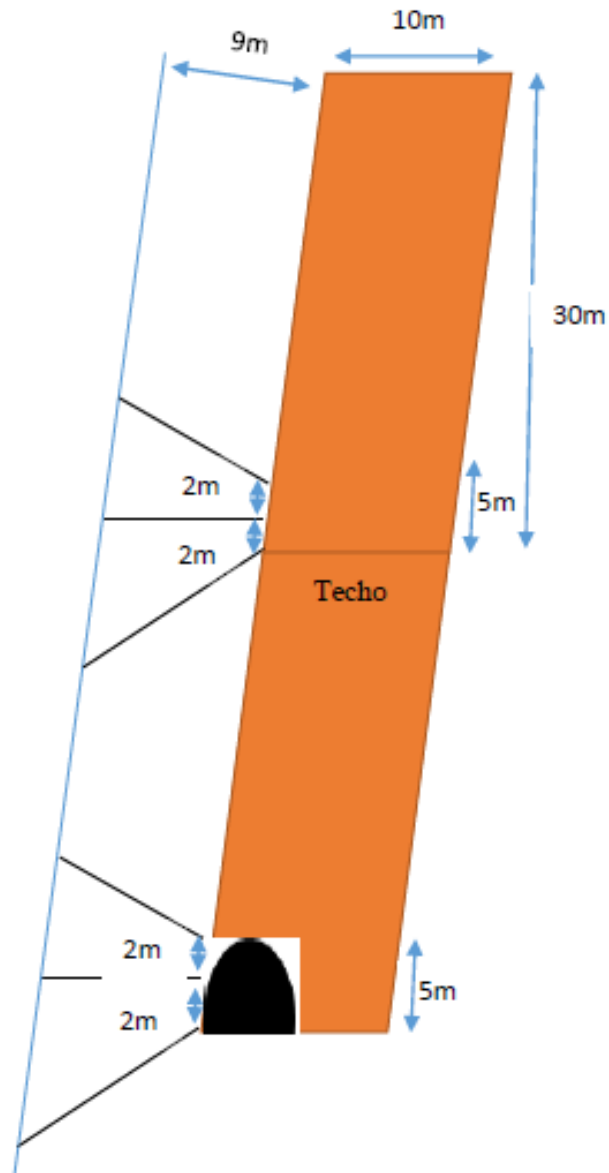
Propuesta de sostenimiento con cables de anclajes dobles para el *hangingwall* en la cámara a 450m.
